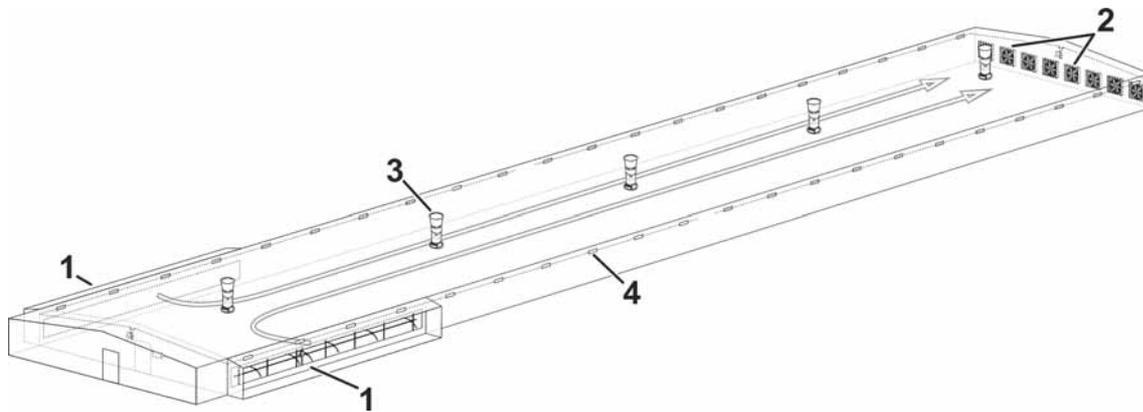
Beispiel eines Lüftungssystems (Tunnelventilation)
